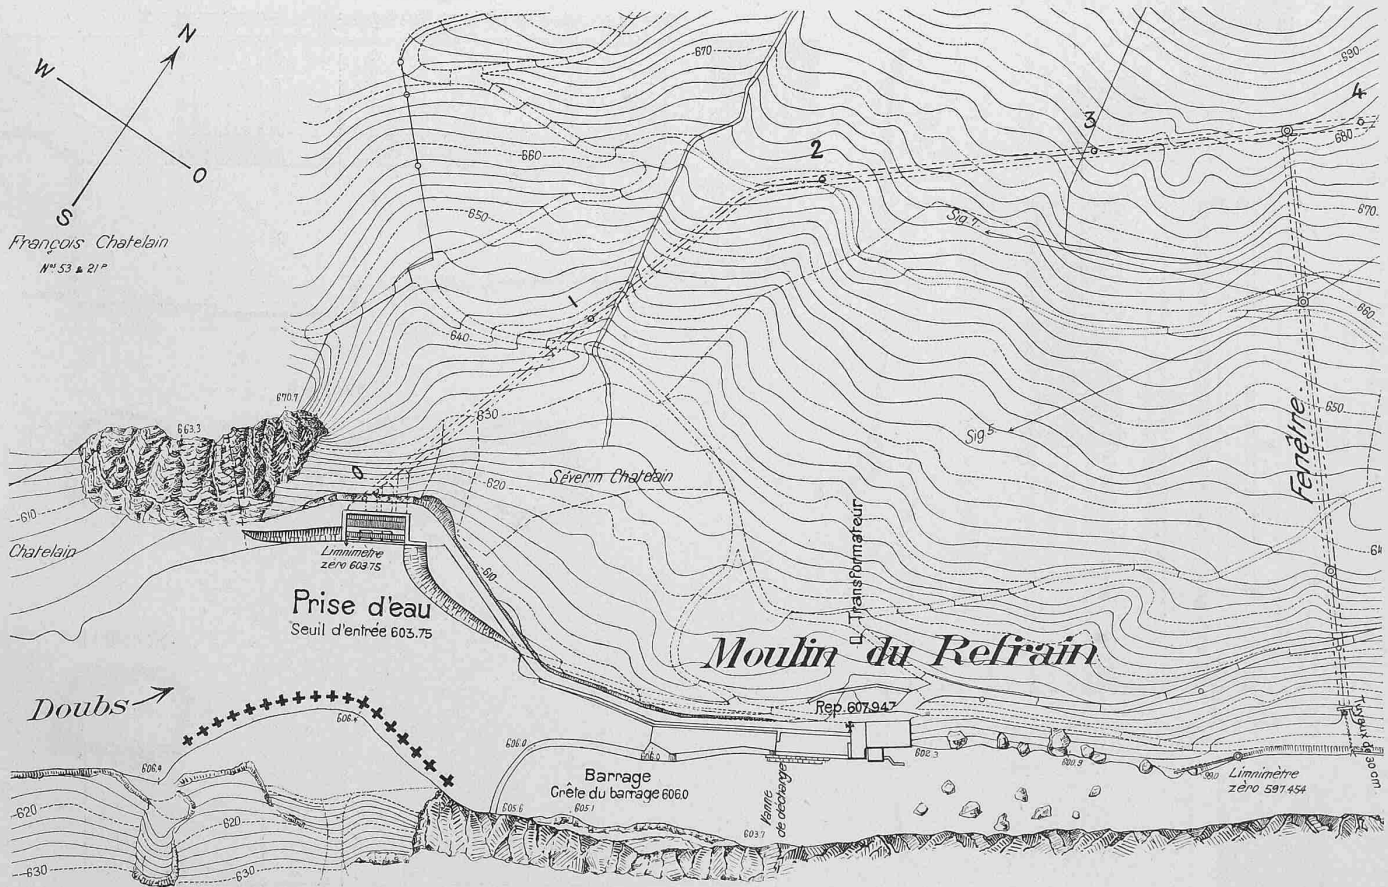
Lageplan der Wasserfassung mit dem bestehenden Stauwehr des «Moulin du Refrain». — 1:2500. (Photographische Verkleinerung des französisch beschrifteten Originalplans.)
